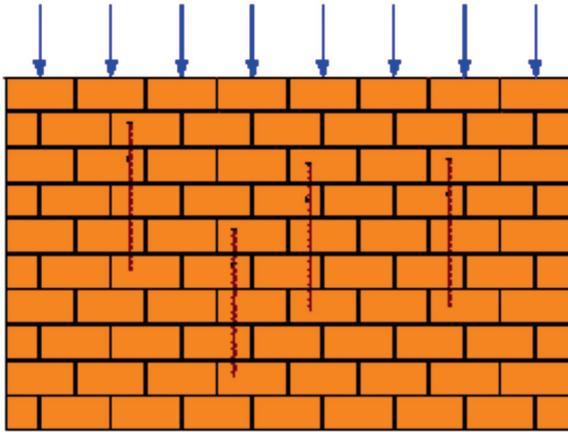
Fissuras verticais ao longo da parede.
